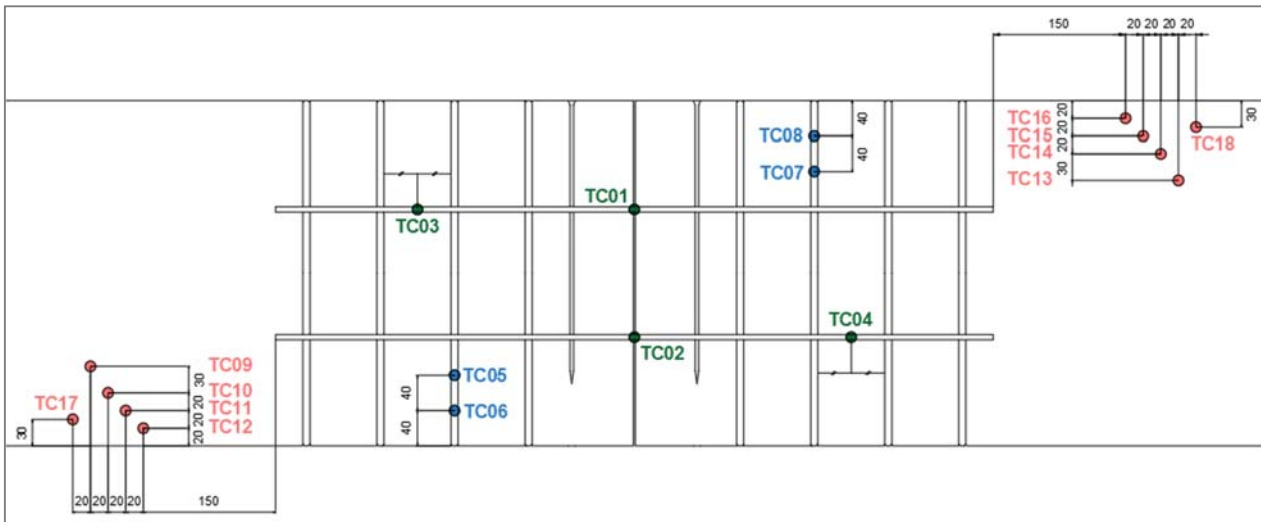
Campagne 2 – Configuration 3 – Vue de haut en coupe horizontale
